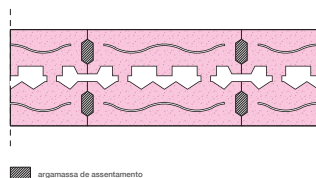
Pormenor do preenchimento com argamassa de assentamento das juntas verticais numa Parede Acústica Isolsónico® 25
